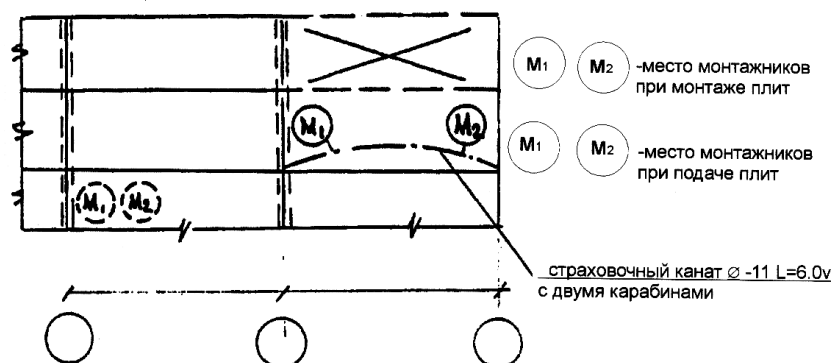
Организация раб. места монтажника при монтаже плит перекрытия
